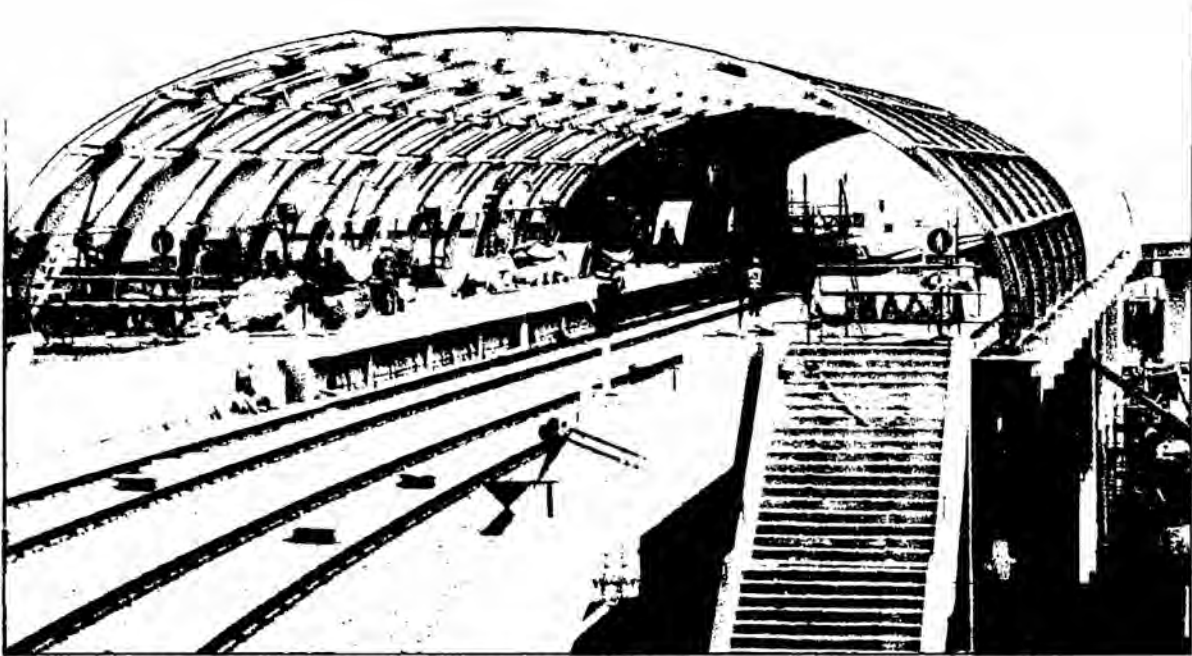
Fotografía - Instalación Cubierta de Techo (Fuente: Tramo 2)
